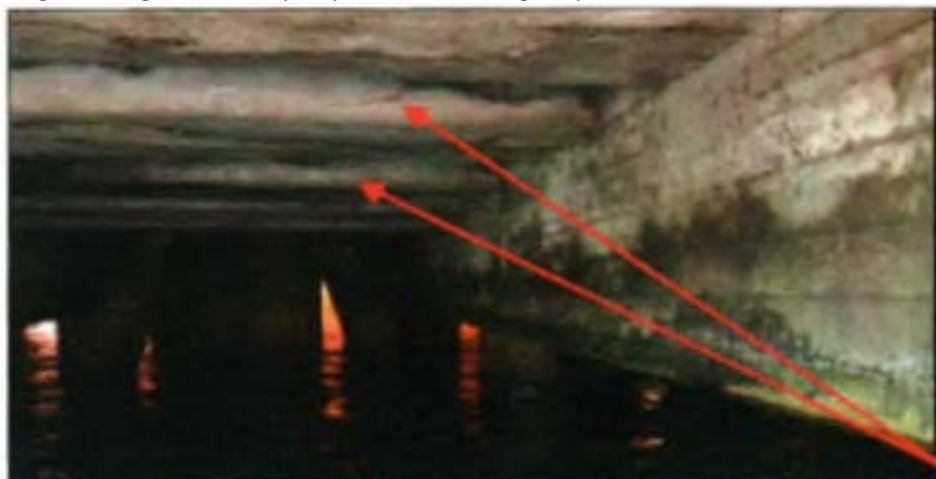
Vista general del Muelle 1 del Terminal portuario de Salaverry
